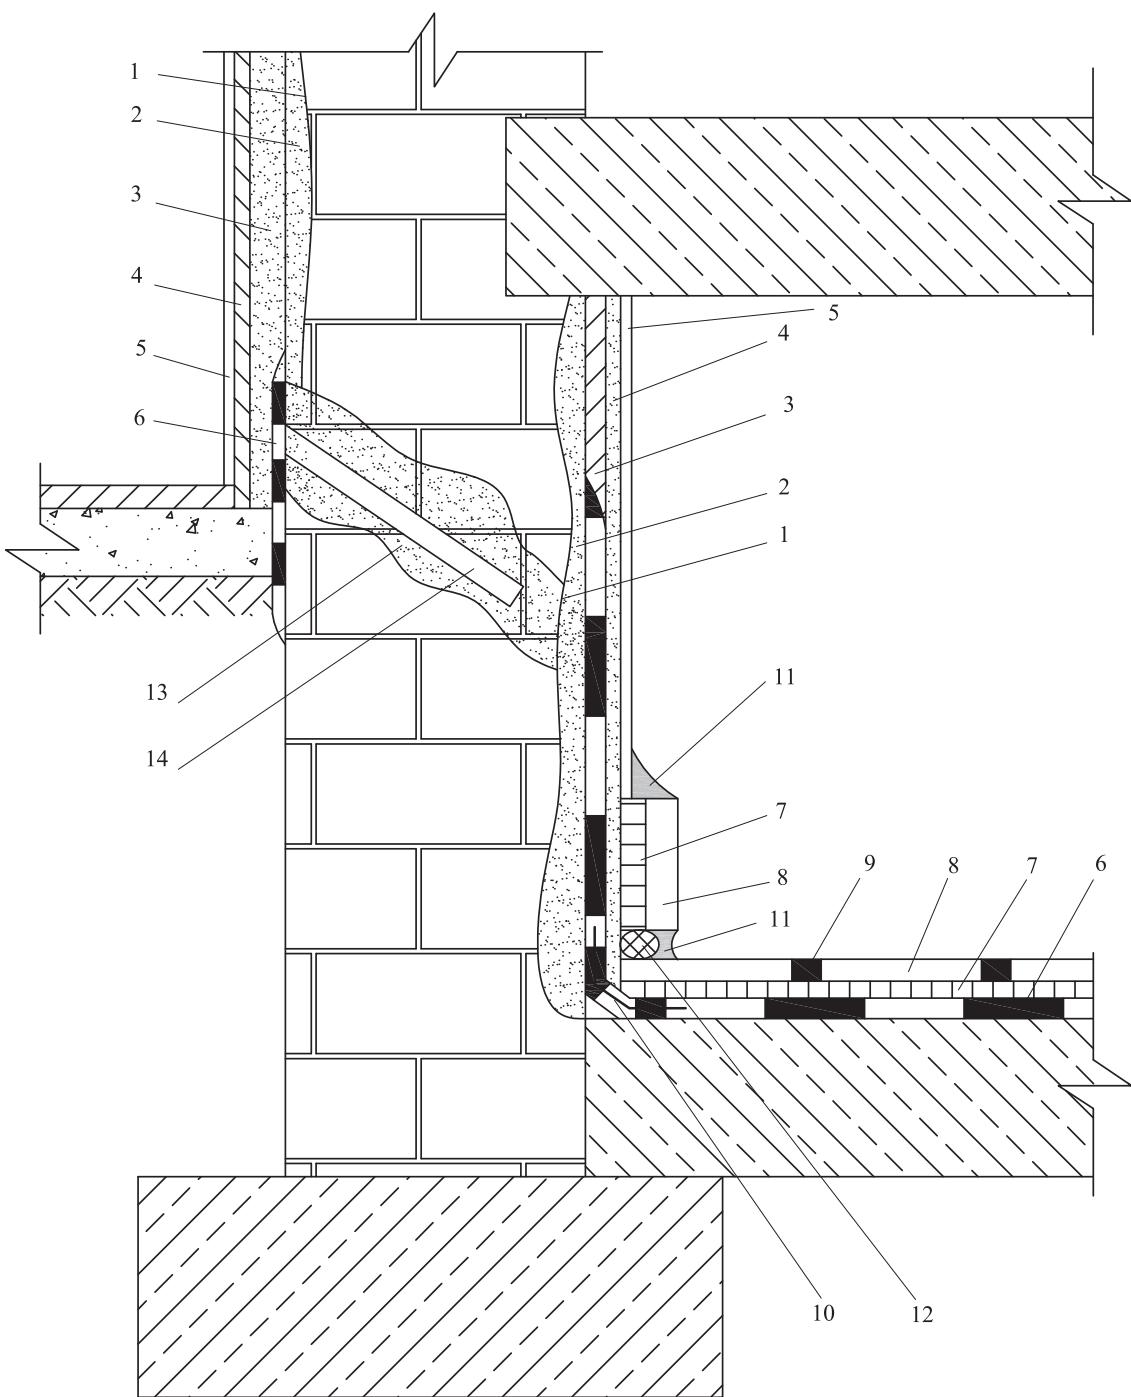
Устройство отсечной гидроизоляции ниже уровня пола первого этажа в условиях периодического незначительного увлажнения стен подвального помещения
